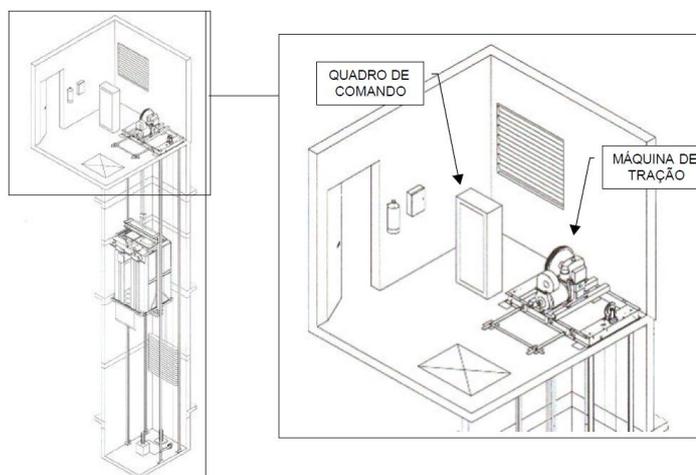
Desenho esquemático de um Elevador com casa de máquinas
